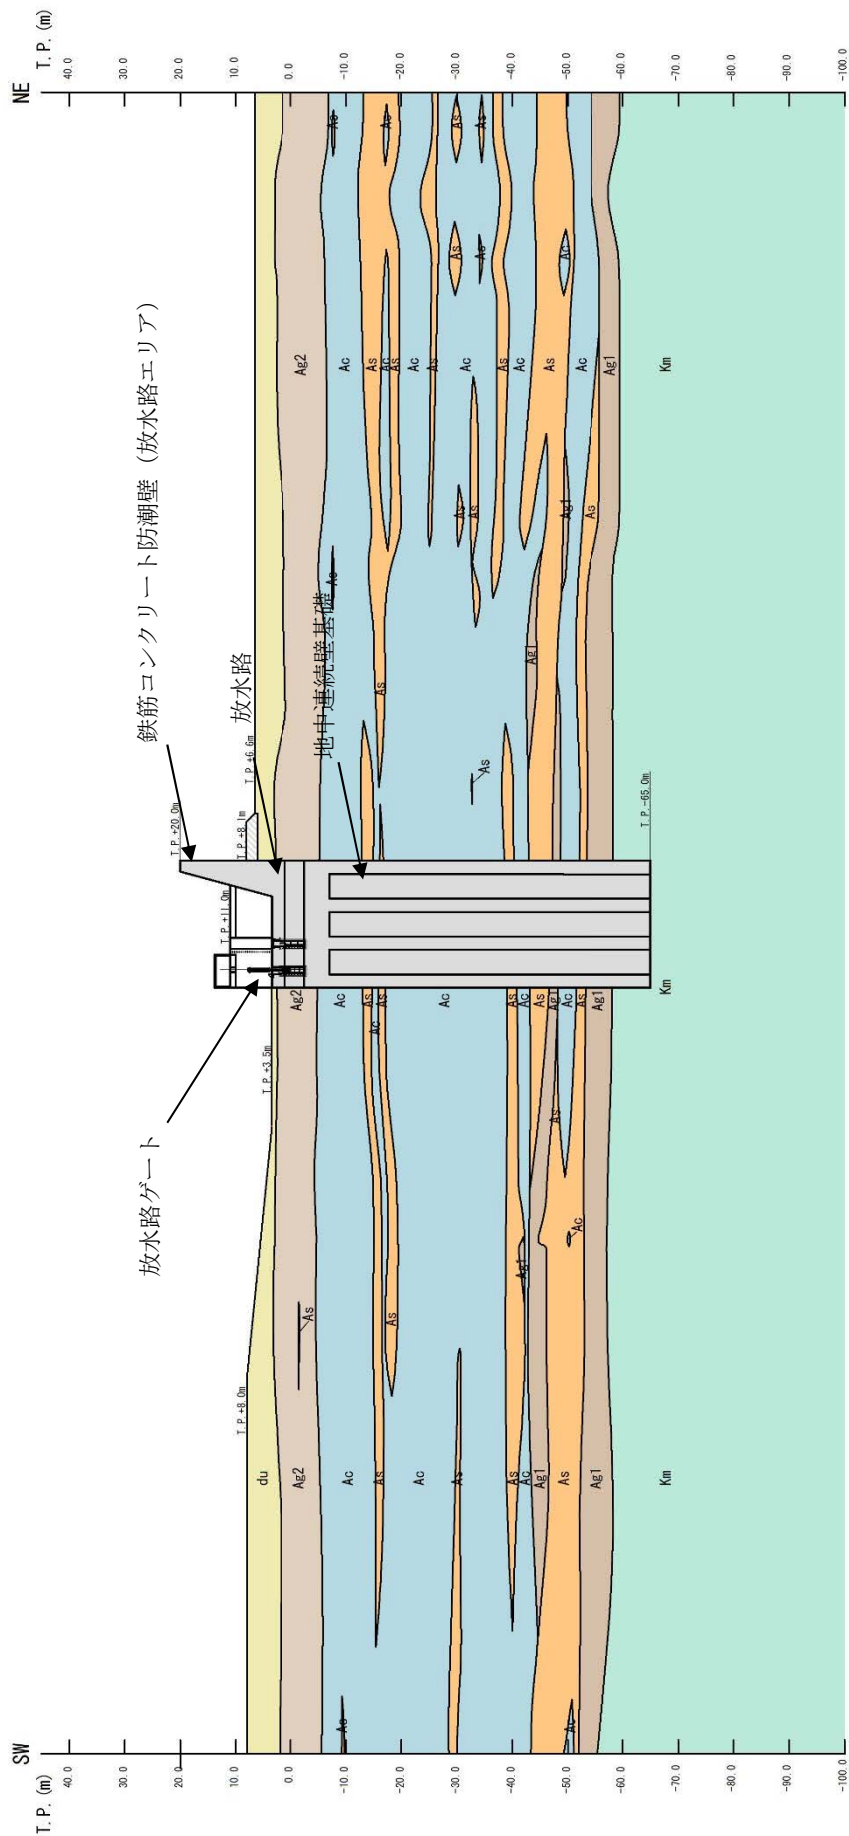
(1) 鉄筋コンクリート防潮壁 (放水路エリア) の評価対象断面図 (防潮壁横断方向：①-①断面)
